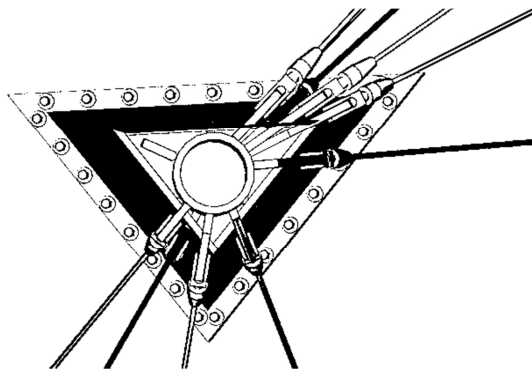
COUPE TRANSVERSALE DU MÂT AU NIVEAU DES HAUBANS
